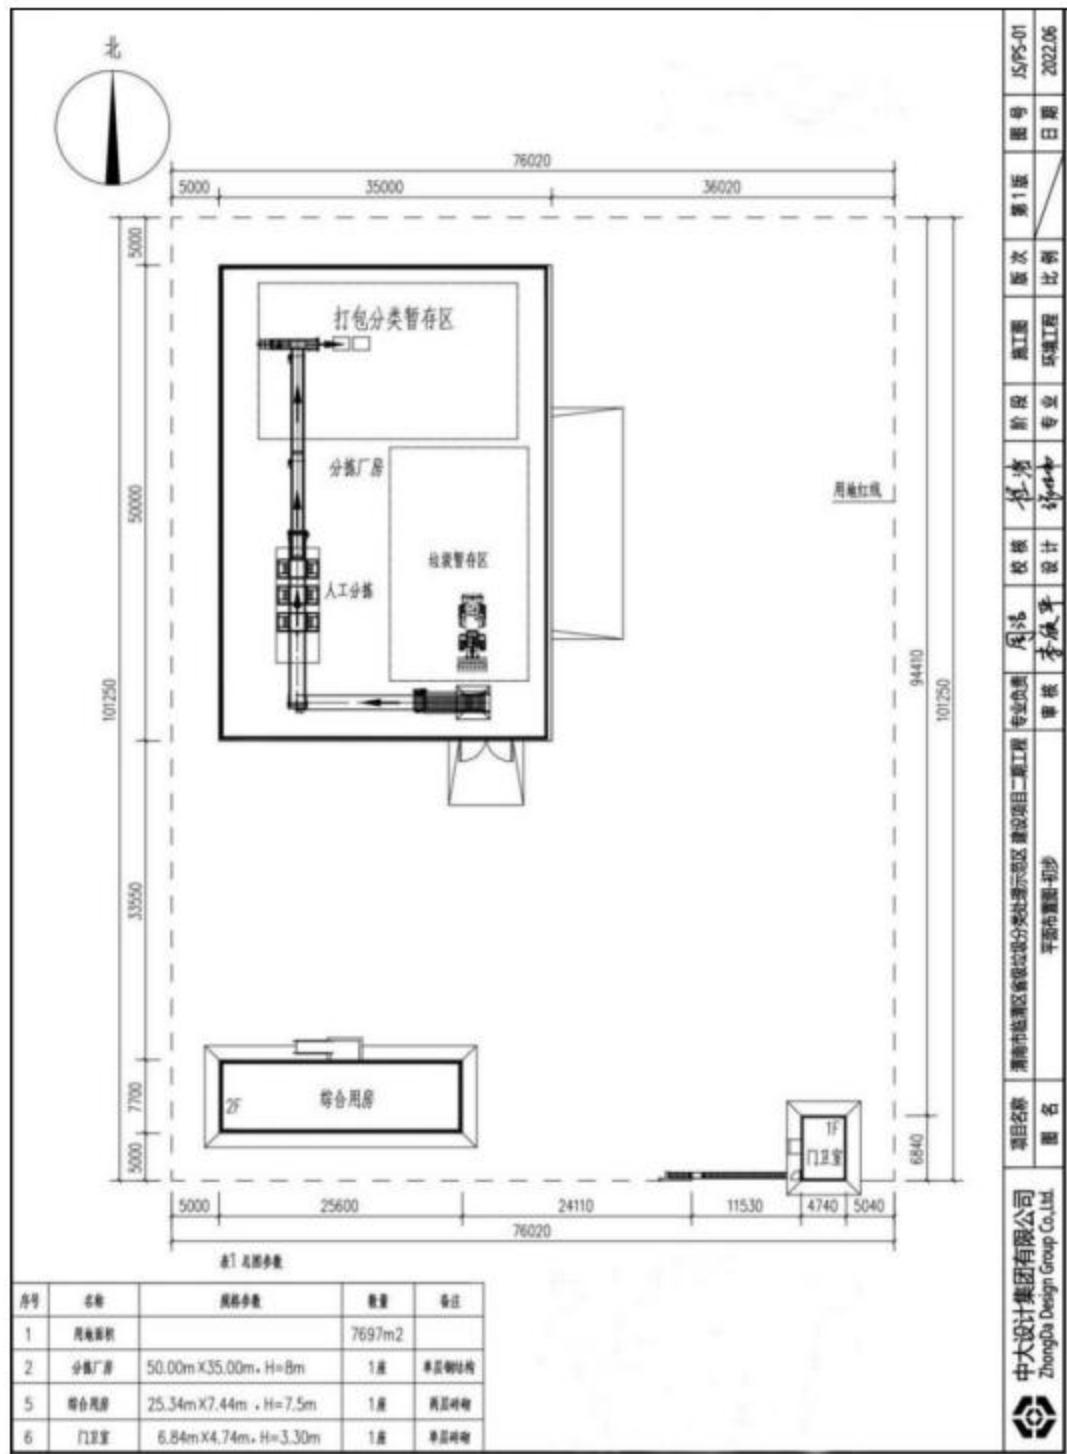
临渭区生活垃圾分拣中心平面布置图
